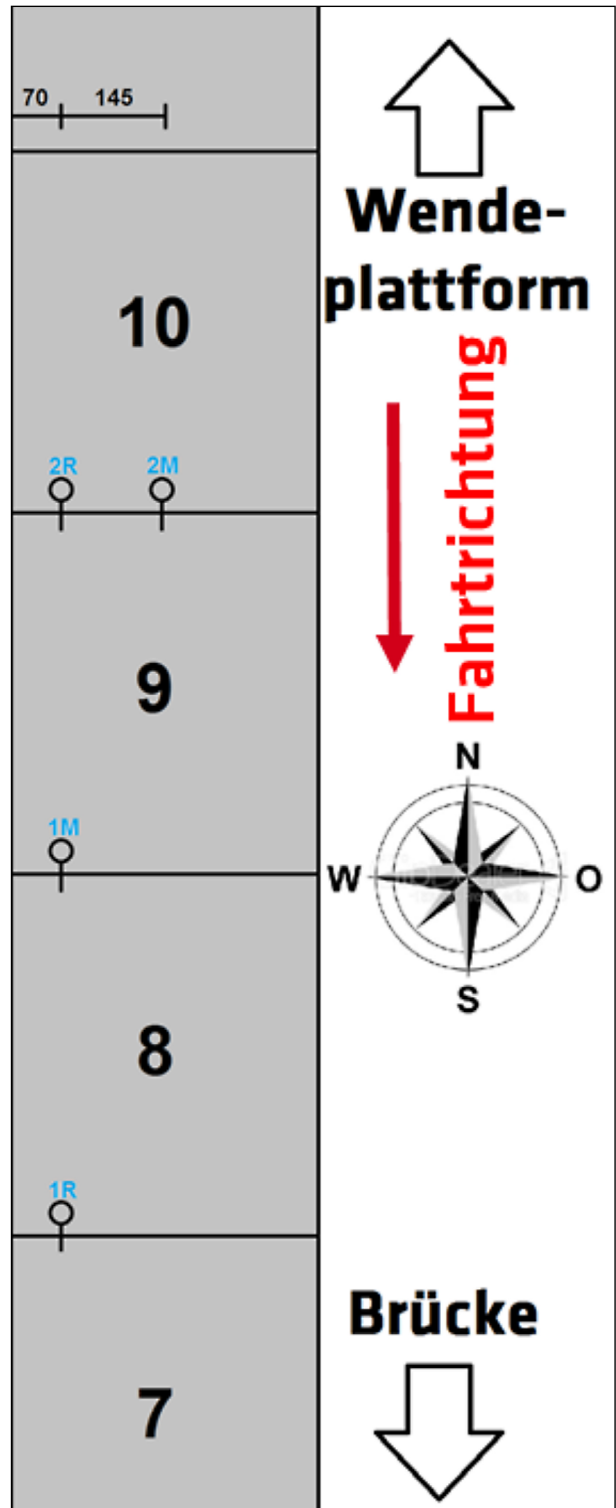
Endgültige Einbaulage in situ auf dem Waschbetonabschnitt 40 des duraBAST; Sensorsystemnummern in blau
